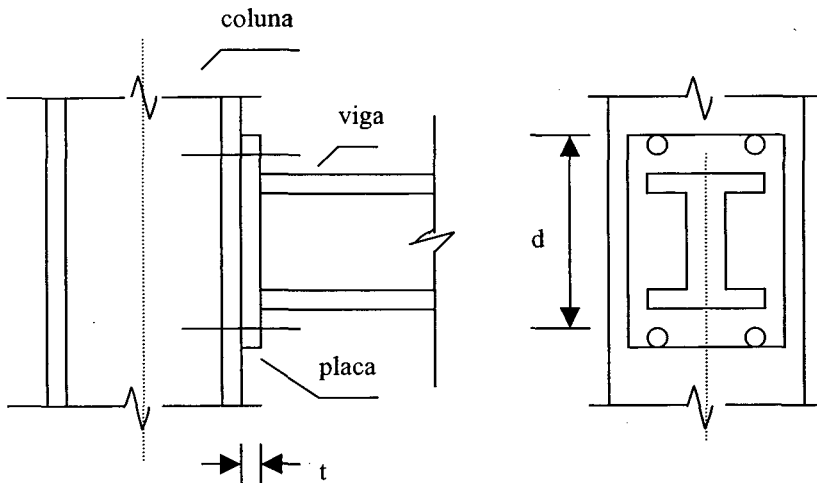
Típica conexão viga-pilar metálica “end plate without stiffeners”.
